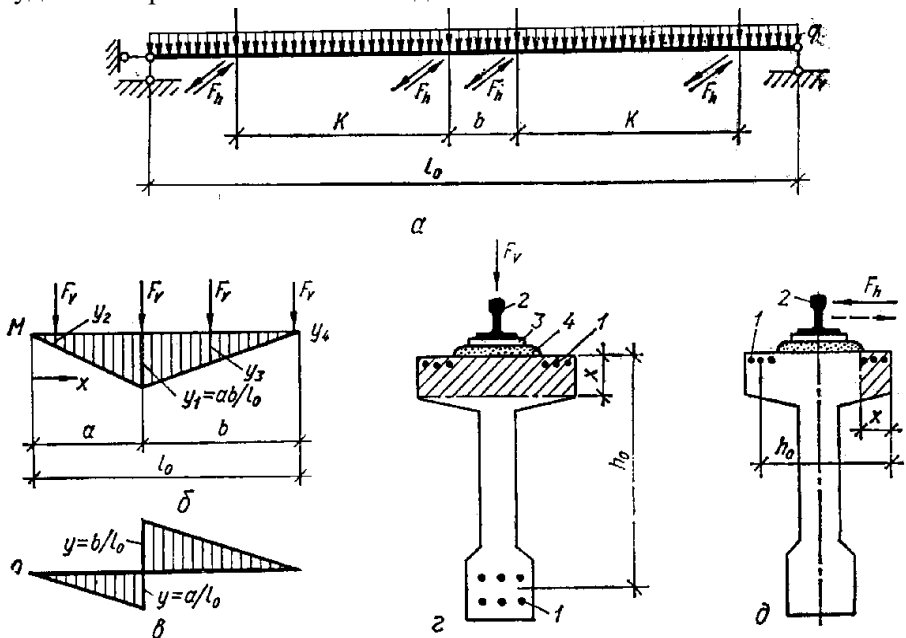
До розрахунку підкранових балок: *a* – розрахункова схема; *б* – лінія впливу  $M$ ; *в* – лінія впливу  $Q$ ; *г* – переріз підкранової балки і розташування робочої арматури при розрахунку на вертикальне навантаження; *д* – те ж, на горизонтальне навантаження; 1 – робоча арматура; 2 – рейка; 3 – металева прокладка; 4 – вирівнюючий шар
